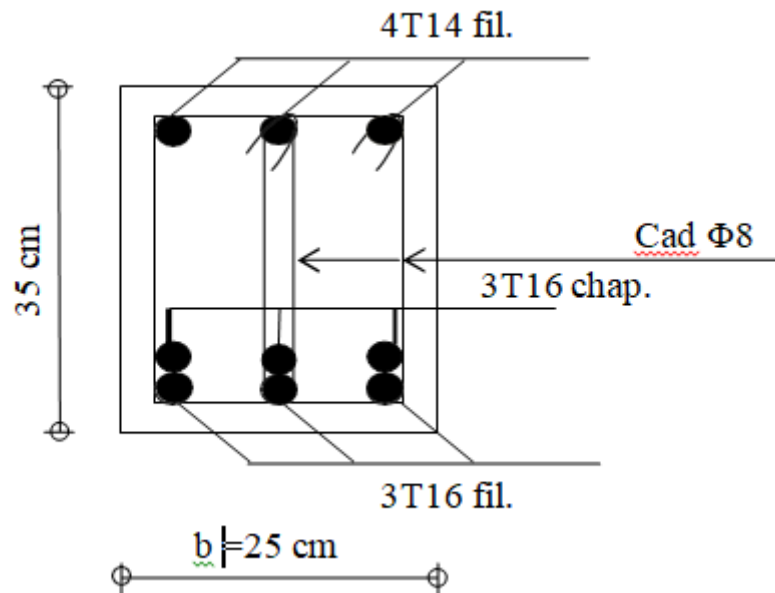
Schéma de ferrailage de la poutre palière.
